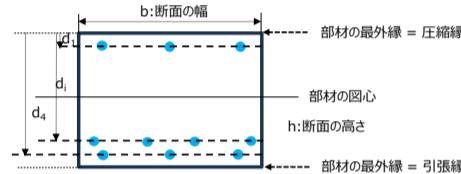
鉄筋コンクリート部材断面、鉄筋配置模式図
